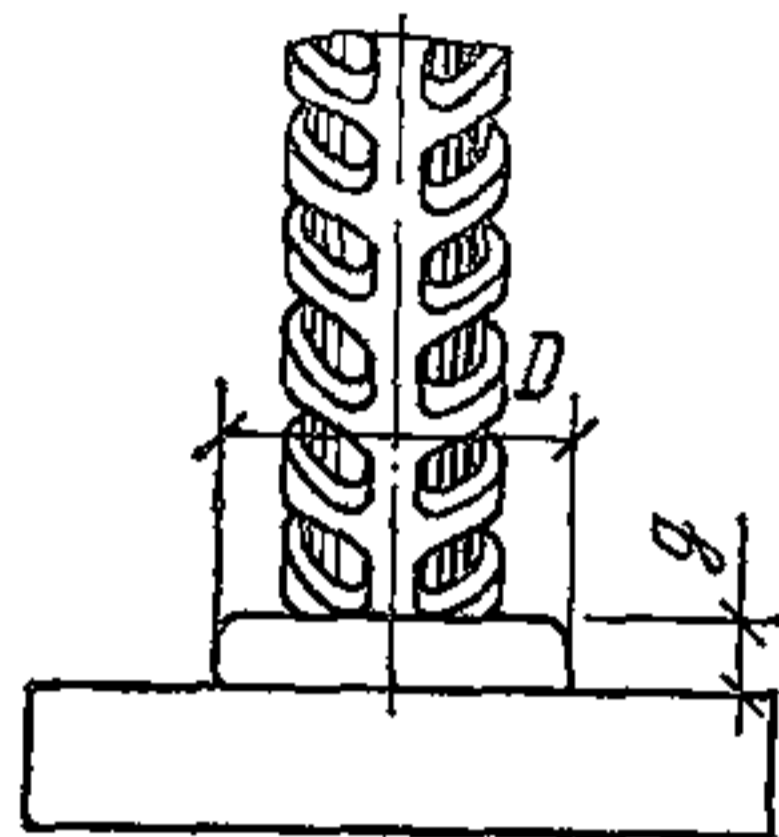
Вид выполненного соединения при сварке под флюсом
